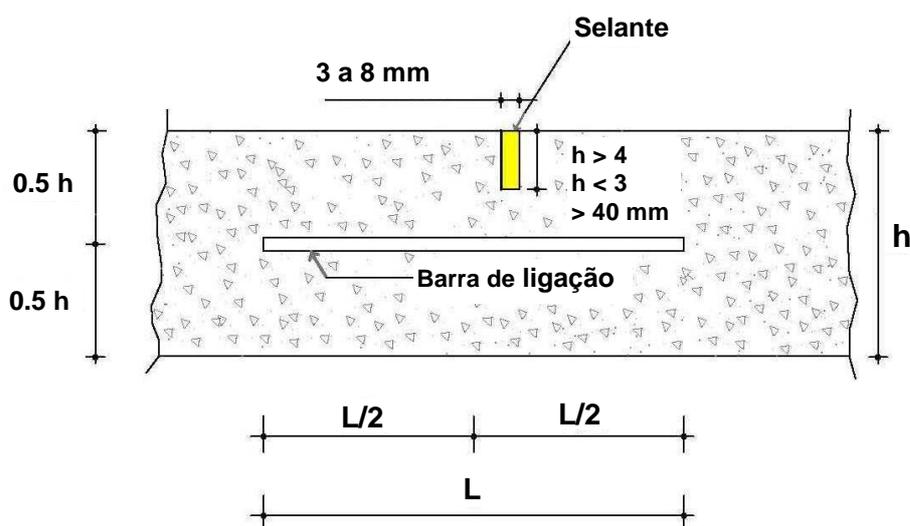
Junta longitudinal serrada e com barra de ligação.
